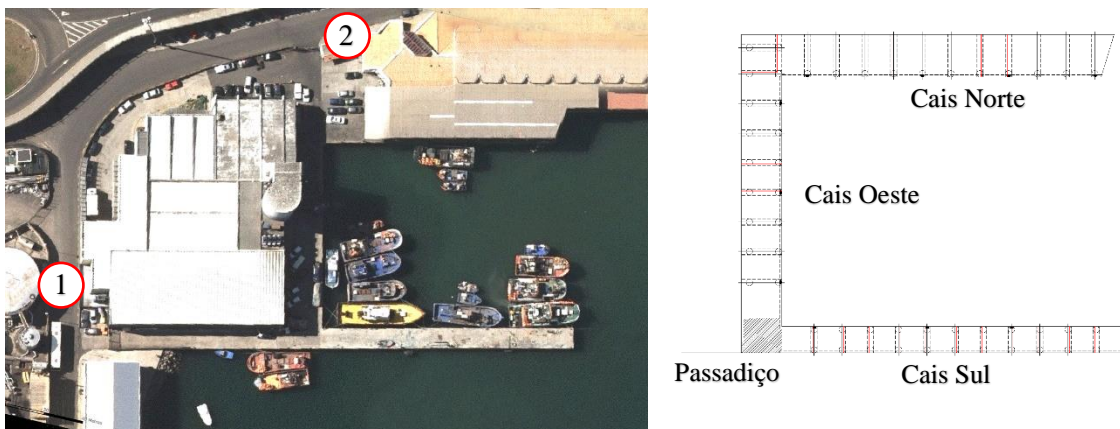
a) Pontos de acesso em ortofotomapa; b) Planta da estrutura
